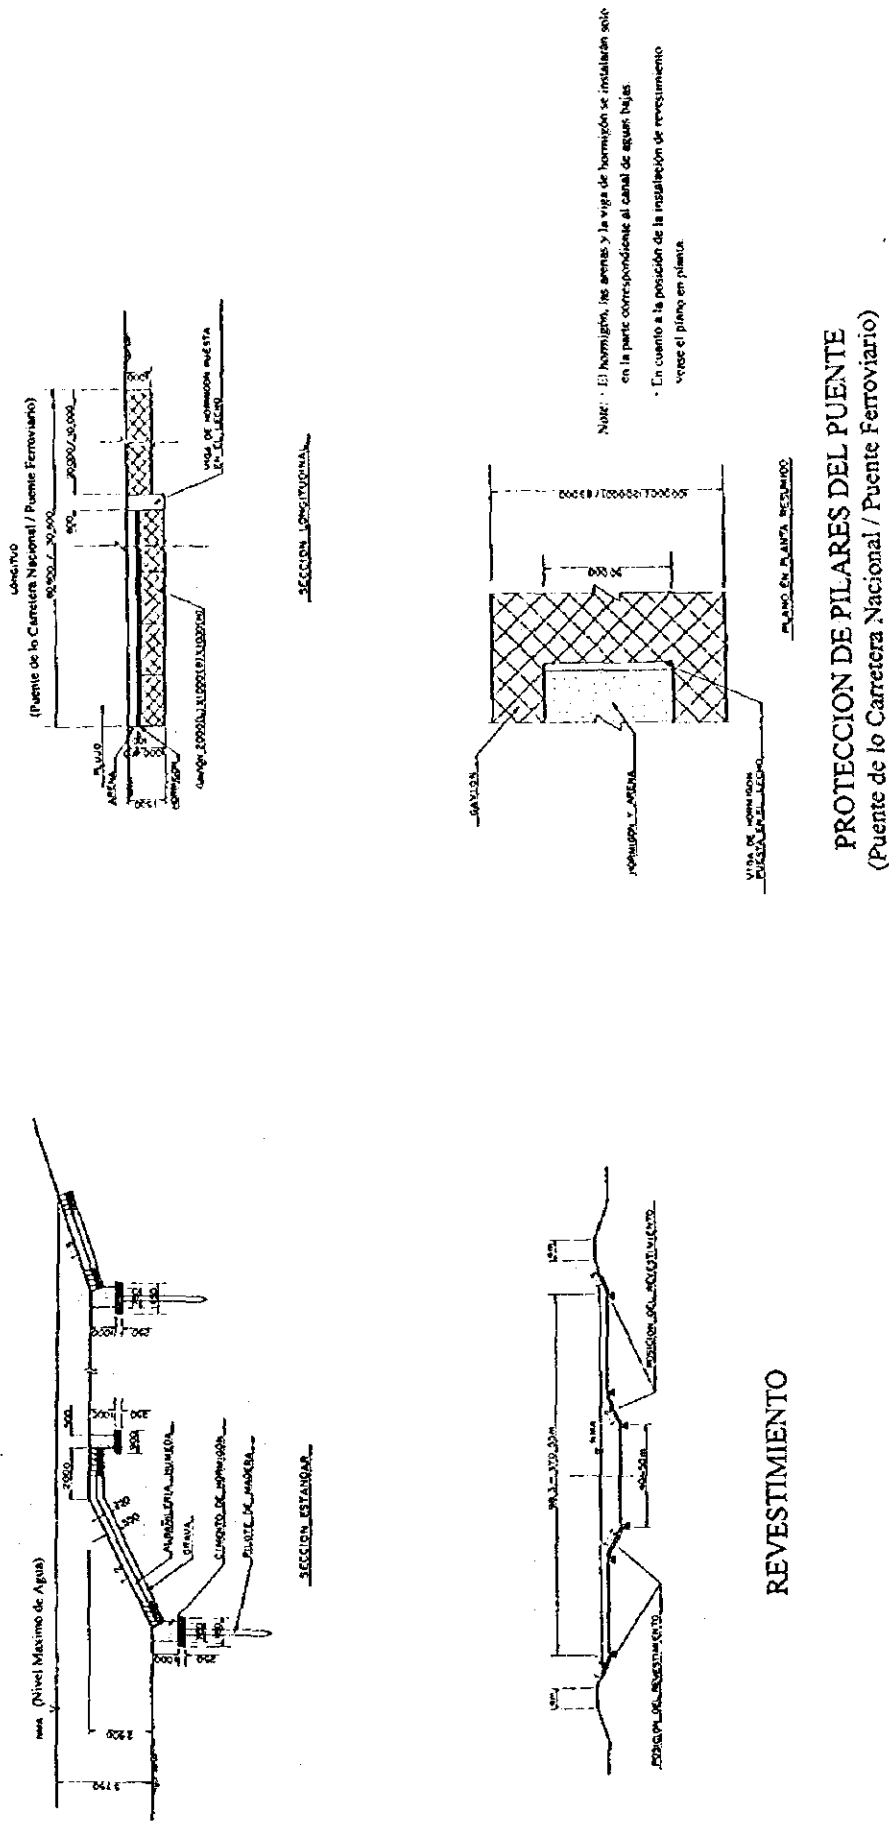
PLANO ESTRUCTURAL DEL REVESTIMIENTO Y PROTECCION DE PILARES DEL PUENTE
